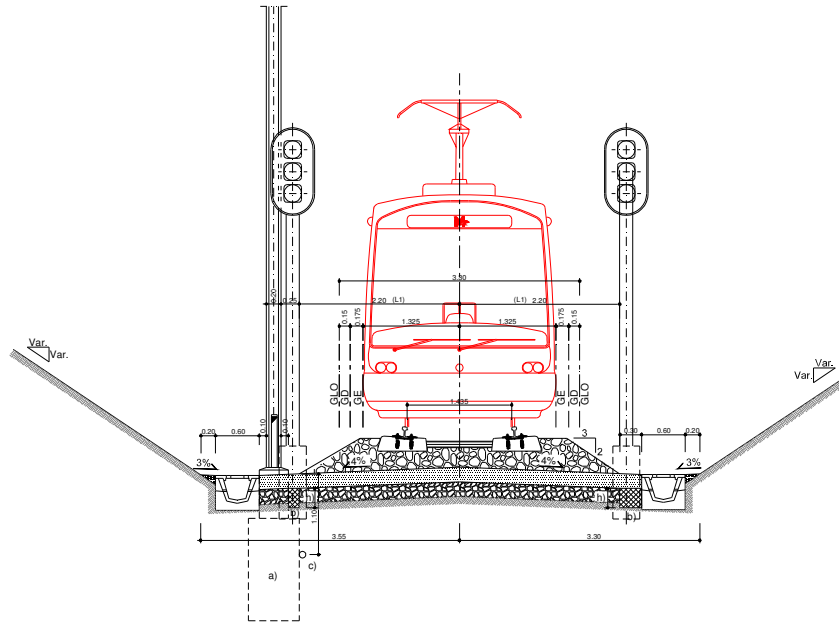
Via única balastrada, em recta, em zona de escavação.
